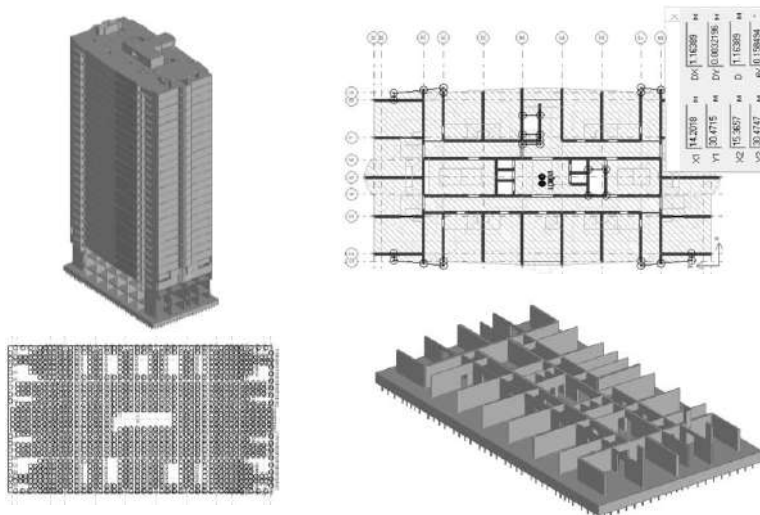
3-Д схема будинку, типового поверху в ПС «Компюновка САПР»
